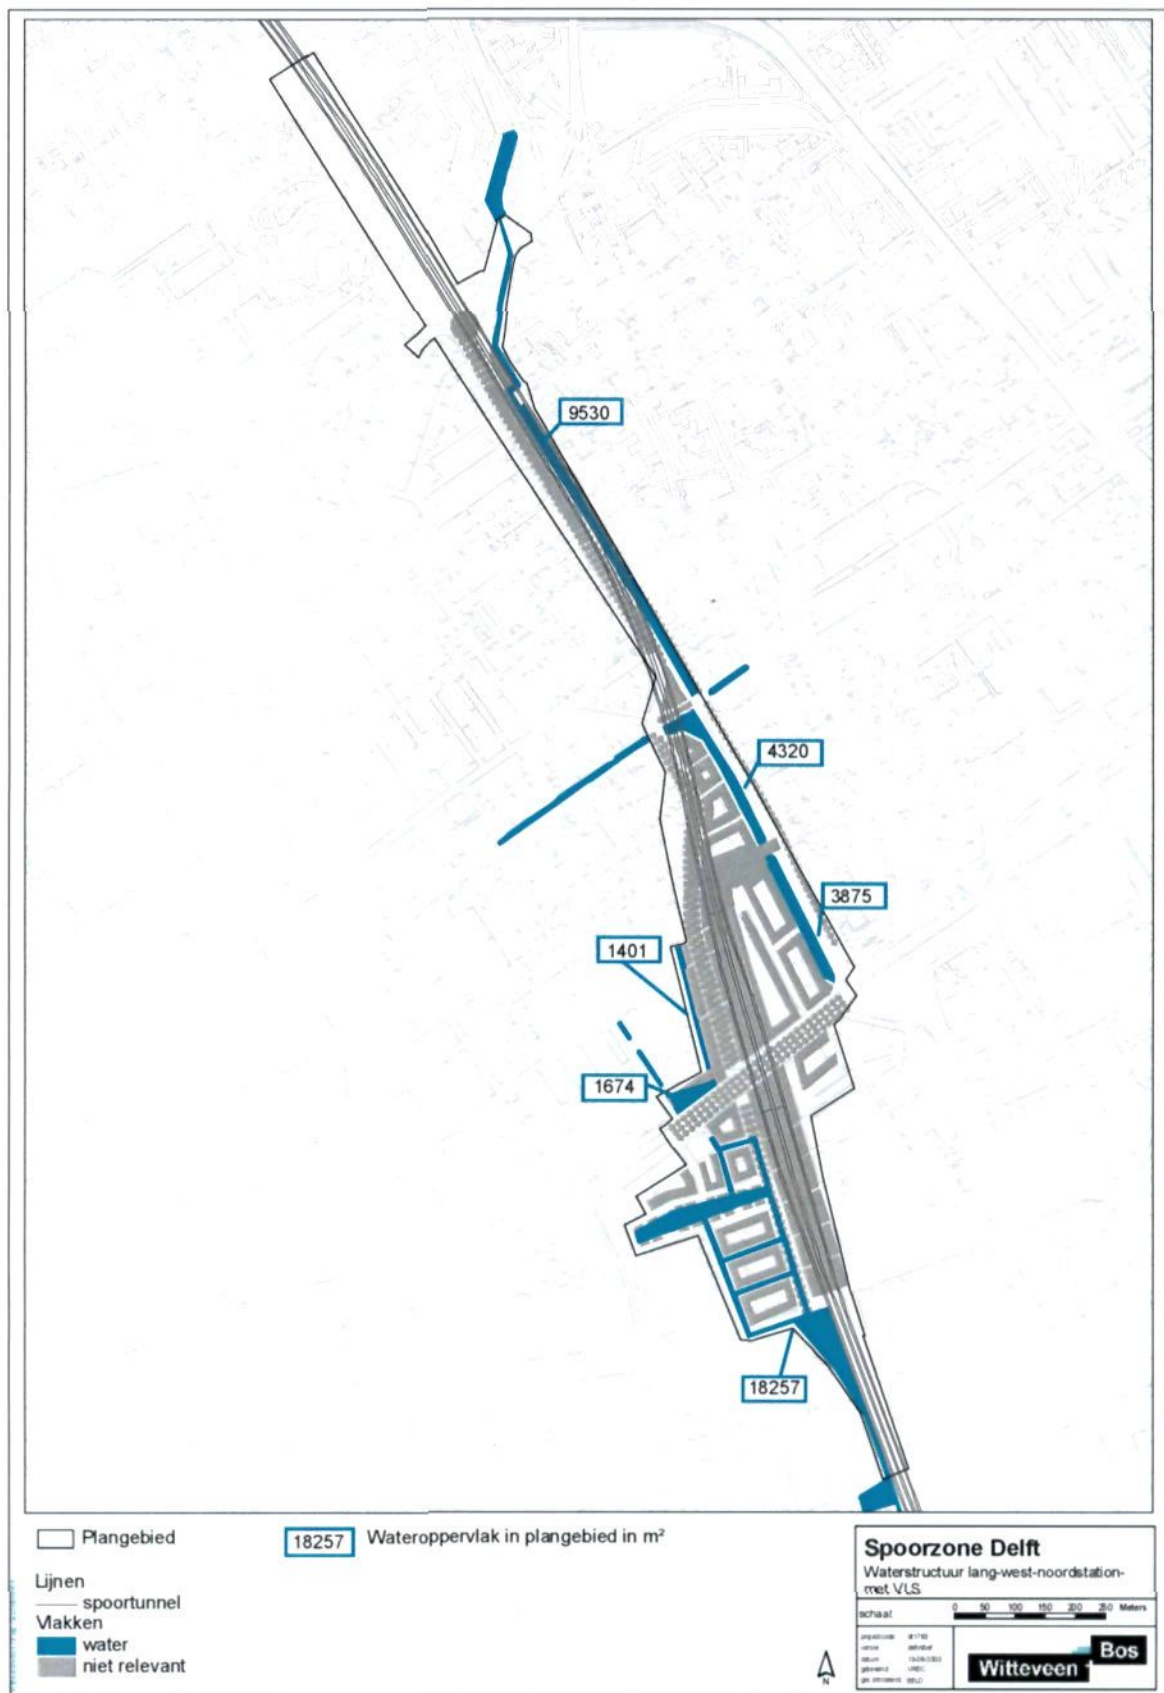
LWN: Lange tunnel, westelijk tracé en noordelijk gepositioneerd station
